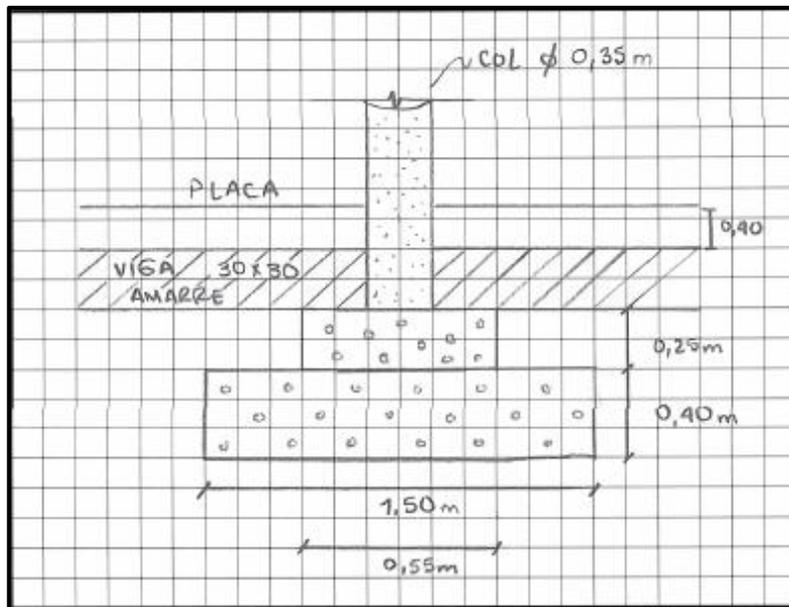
Detalle de la cimentación existente en el edificio de la sede del SENA – Edificación No. 1 Bloque Automotriz.
